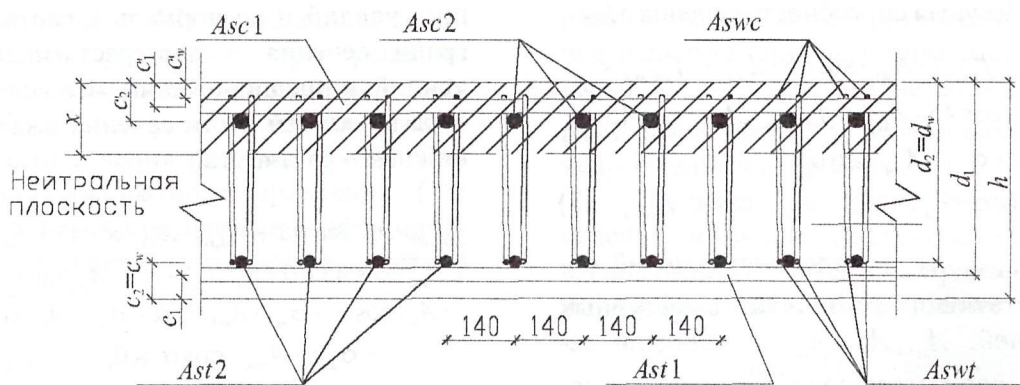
Фрагмент продольного армирования шестиугольной железобетонной плиты с расположением сжатой зоны в верхней части сечения
